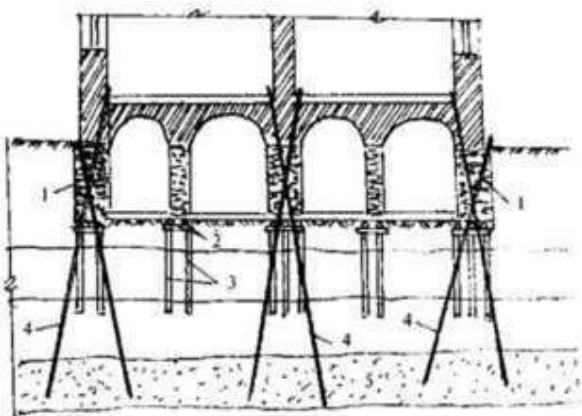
Укрепления фундаментов старого дома города Касбы с помощью свая.
